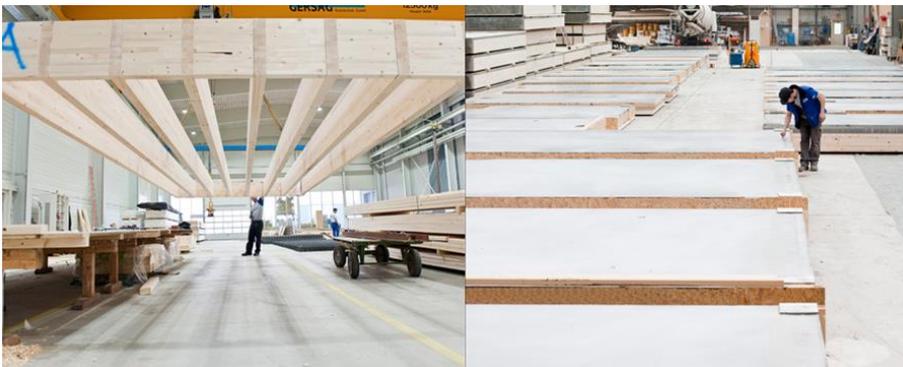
Holzbalken und Ortbeton¹⁴¹
